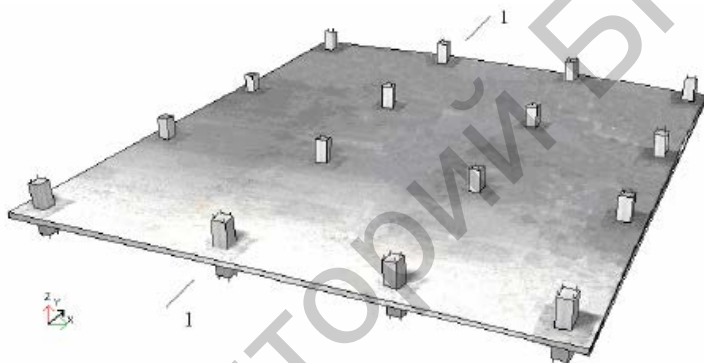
Общий вид железобетонного безбалочного перекрытия
